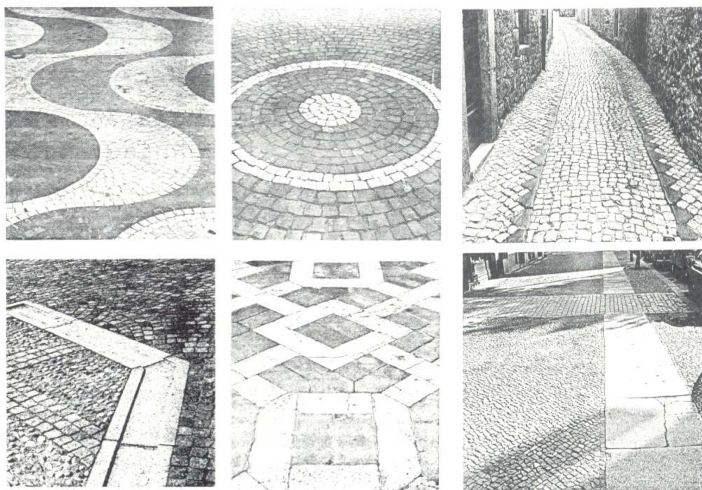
Pavimentaciones en la ciudad de Sazio.
